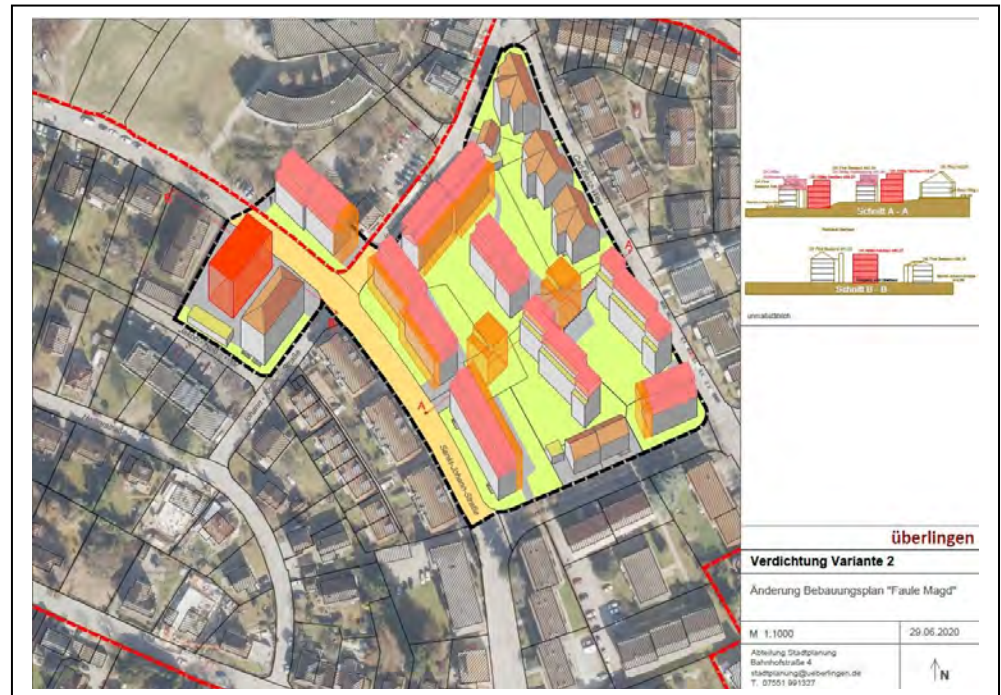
Änderung Bebauungsplan „Faule Magd“ (Variante 2) vom 29.06.2020 (STADT ÜBERLINGEN in lit. 2021)
